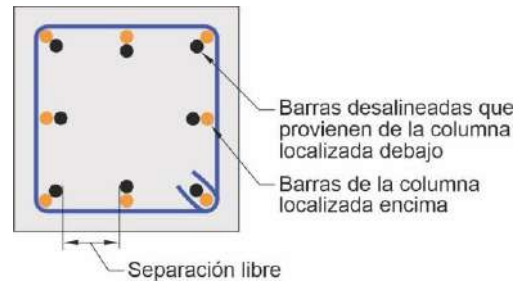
Barras desalineadas en columnas
